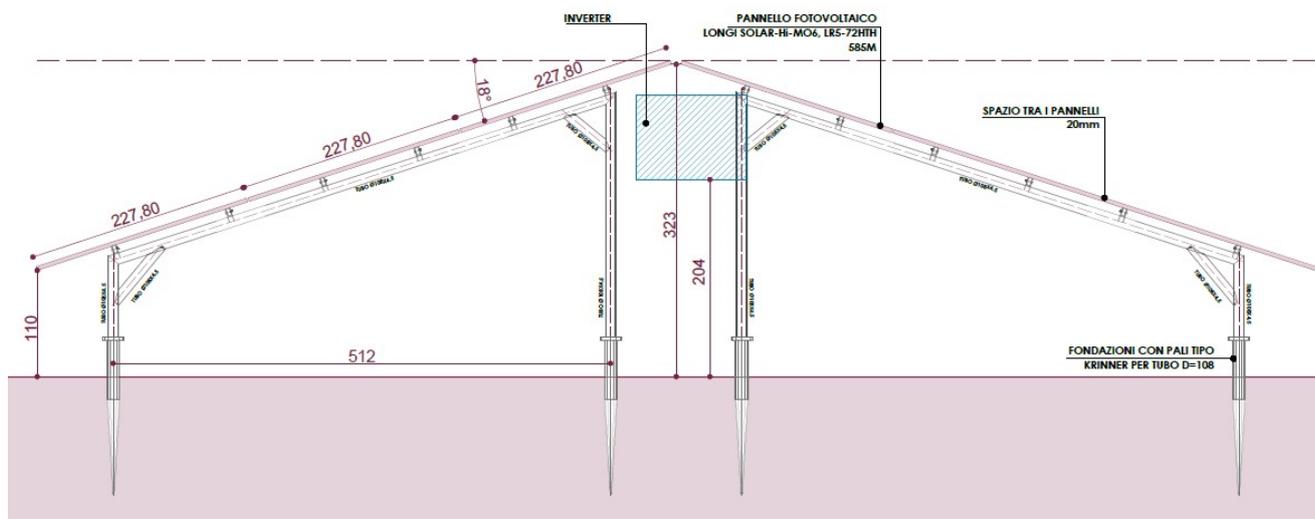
Prospetto delle strutture di sostegno. Stralcio dell'elaborato "T30.3\_Disegni architettonici pannelli particolari ancoraggi"
